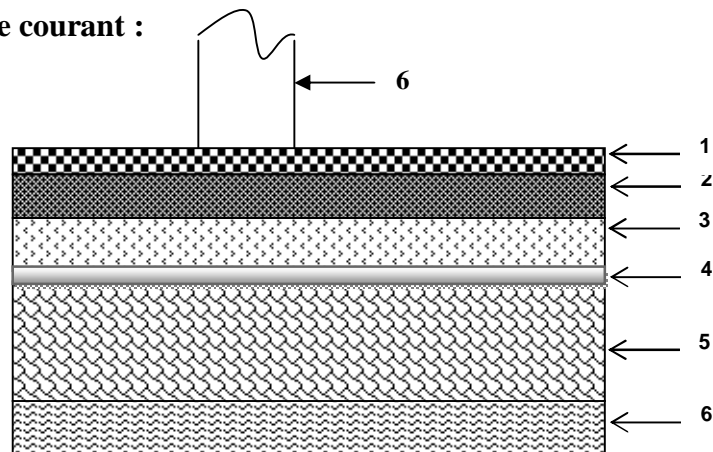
Coupe transversale d’un plancher d’étage courant.
